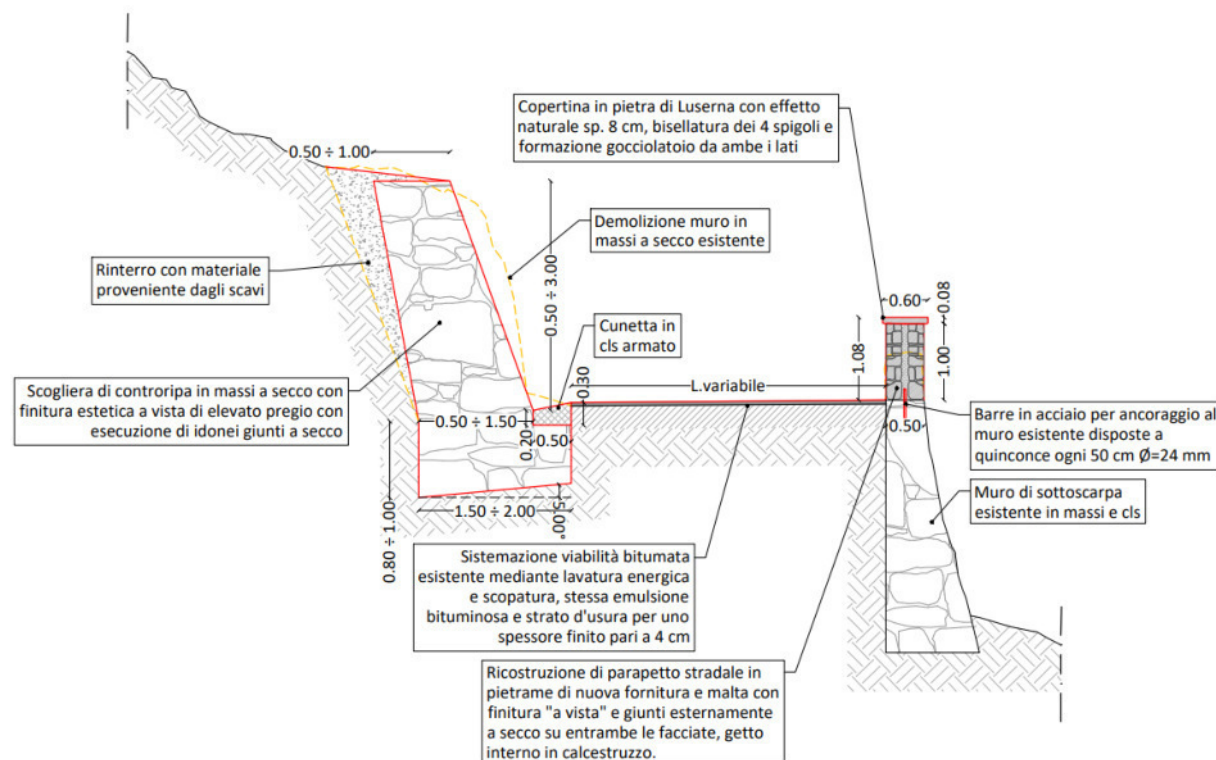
Sezione tipo scogliera e parapetto – interventi 1 e 2.
